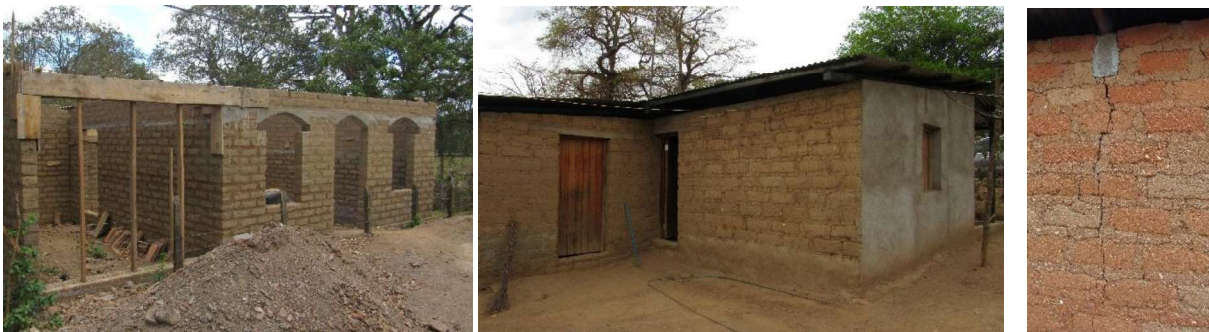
Izq: Vivienda en construcción en Jalapa. Centro: vivienda rural en Jícaro. Derecha: detalle de apoyo de viga de techo
